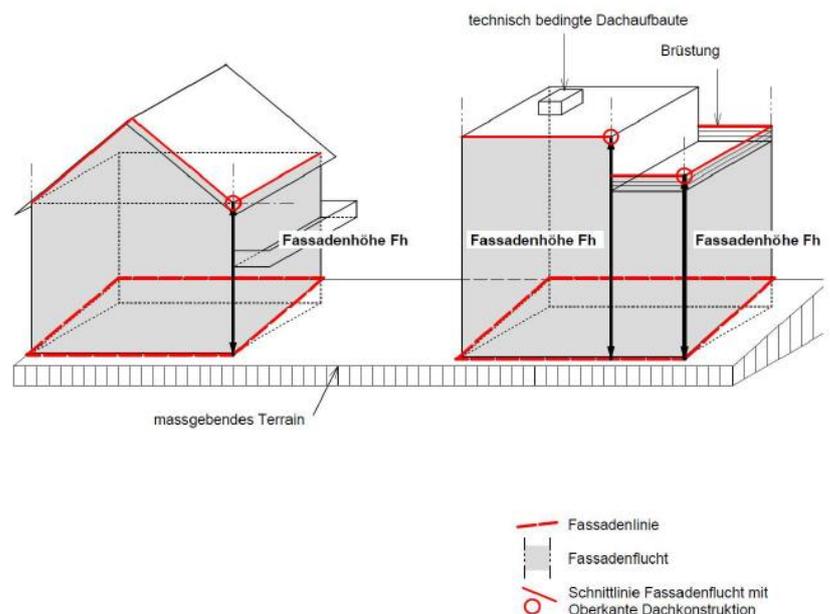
Fassadenhöhe gemäss kantonomer Bauverordnung, Anhang 1 Figur 6 Fassadenhöhe KBV
